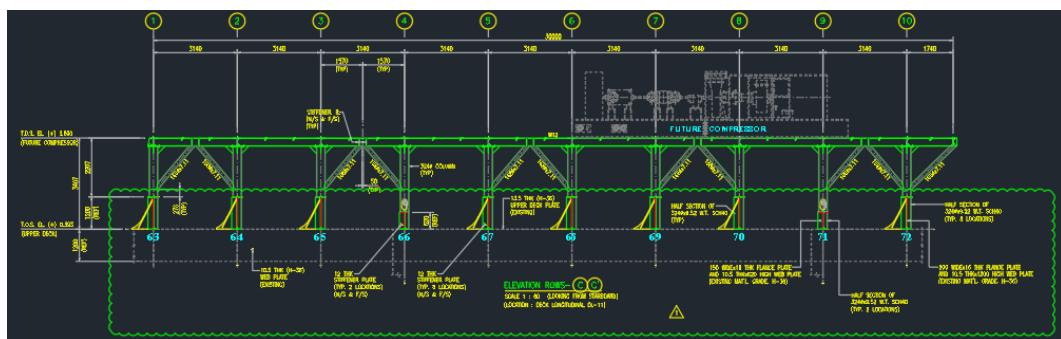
Elevation Rows 1 (Section Melintang di fr. 63)
